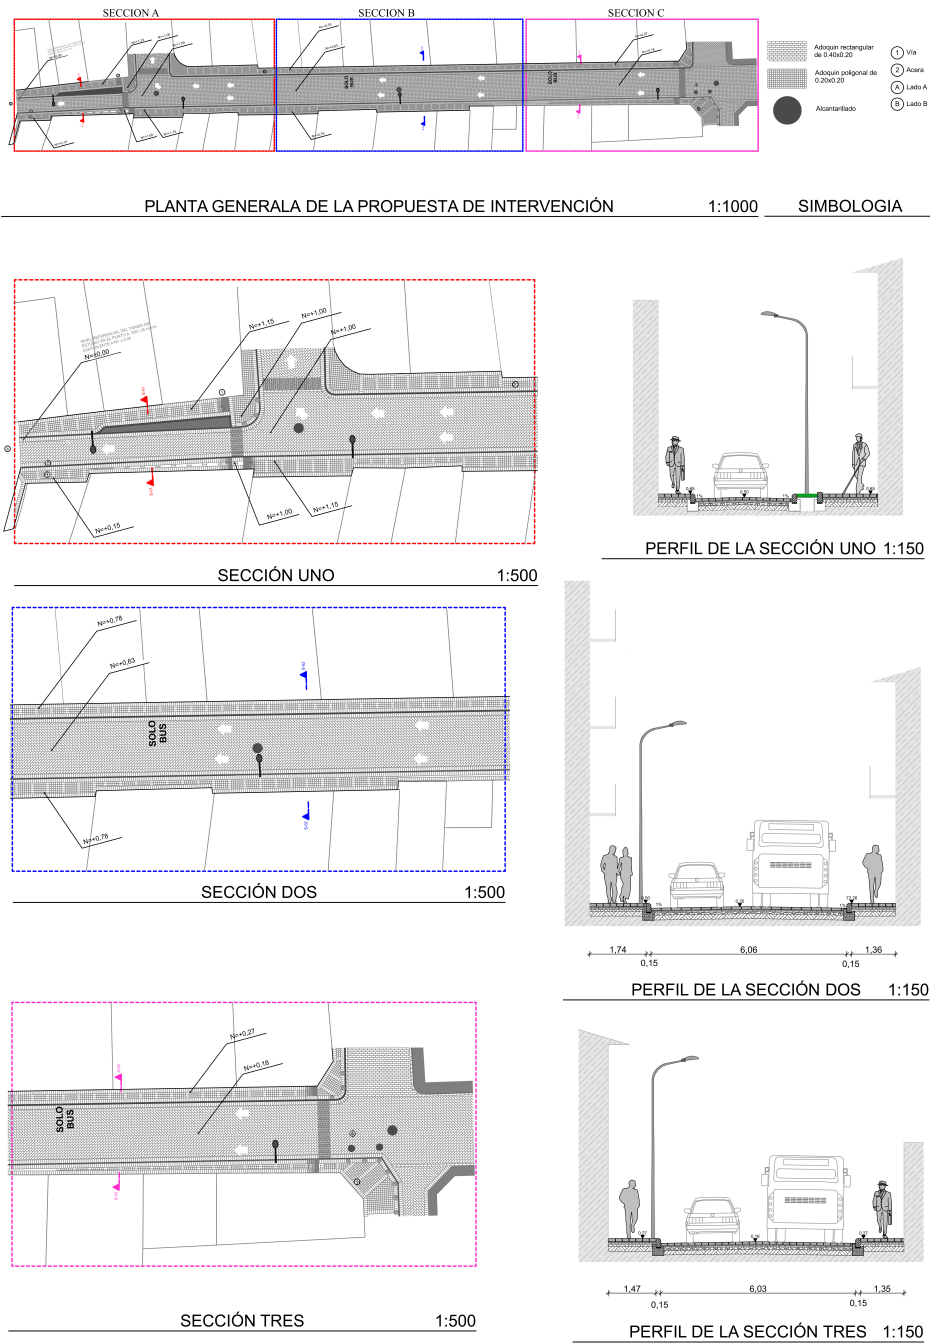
Planta arquitectónico de la propuesta de la propuesta de intervención en el espacio público del tramo de estudio.
